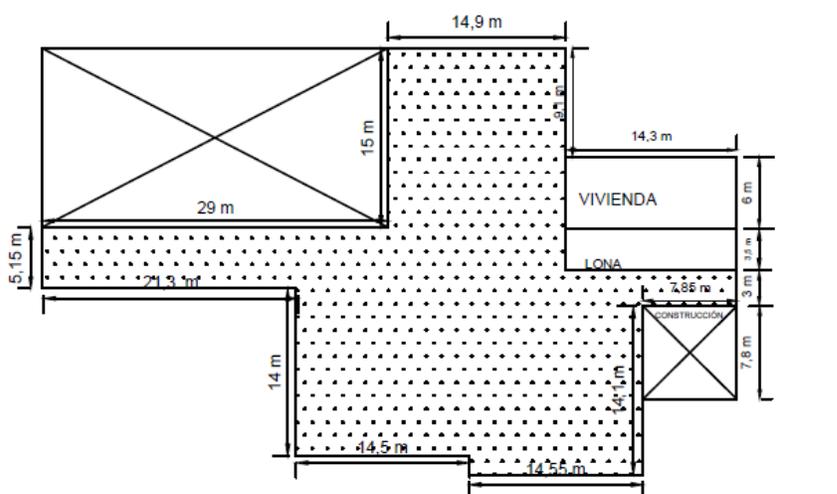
Vista en planta - Lotes Fuente: Edición propia
